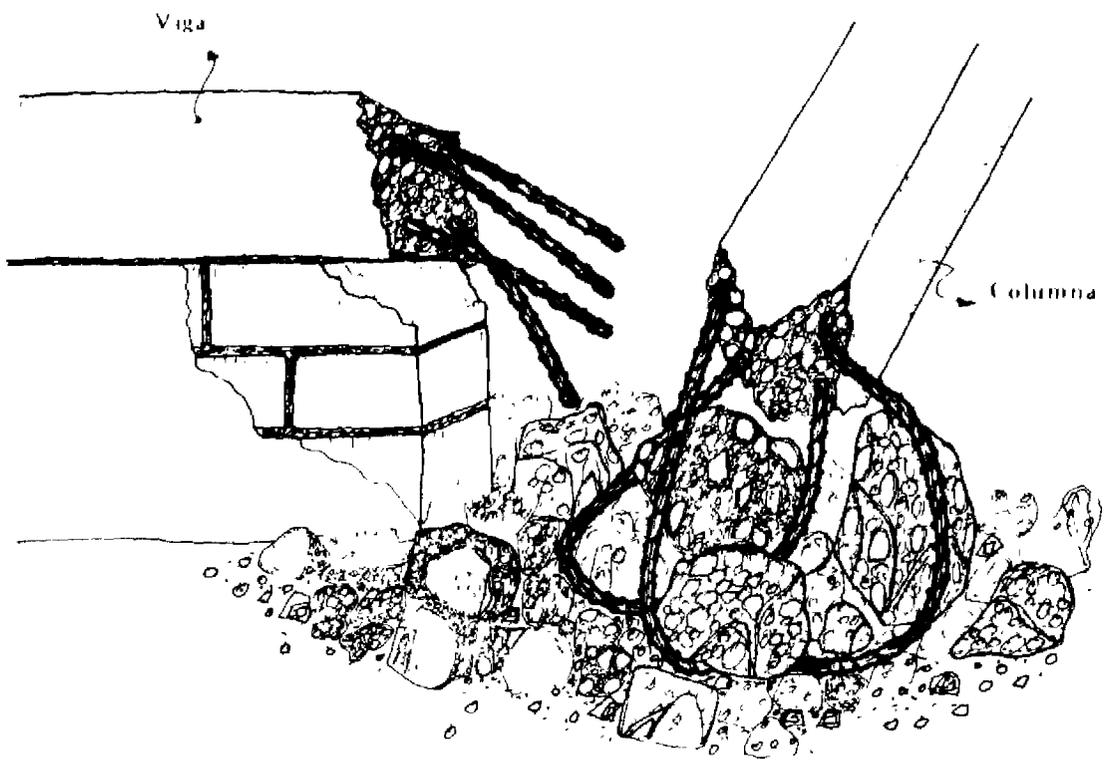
Falta de anclaje de las varillas de la viga en la columna
